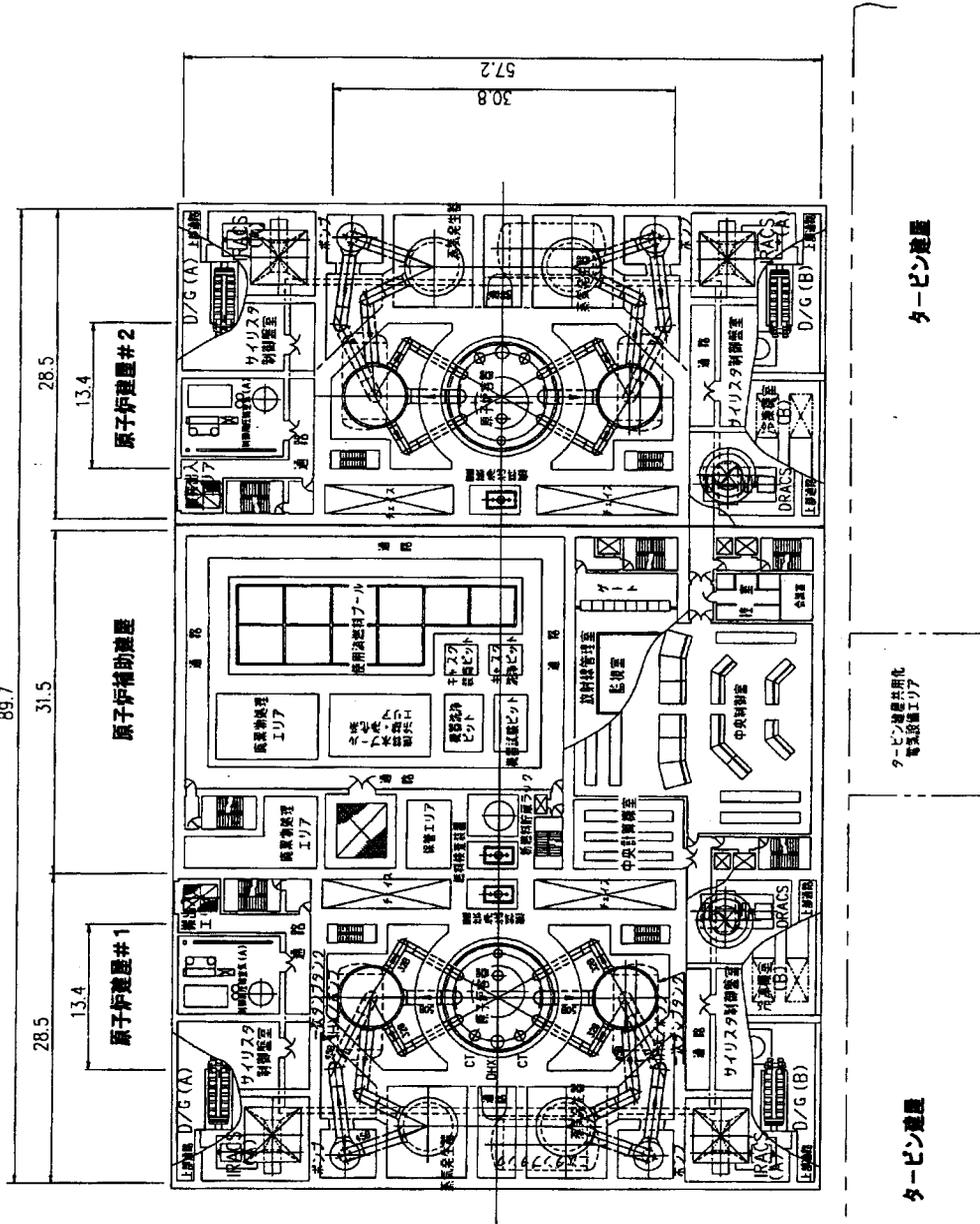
ナトリウム冷却大型炉の配置平面図
